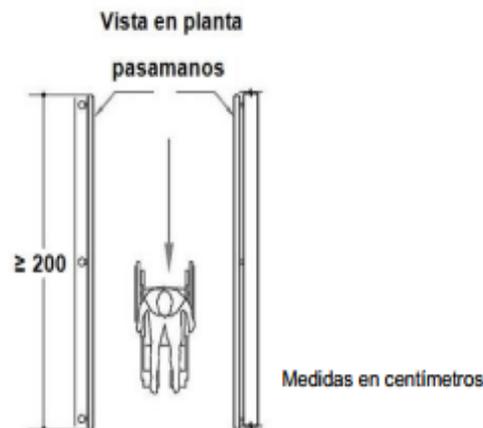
Vista en planta de un usuario en rampa disponiendo de pasamanos a ambos lados.
